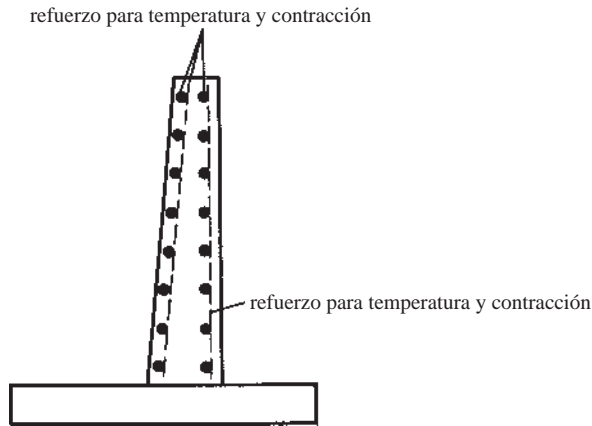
Muro de retención tipo voladizo con vástago ahusado.
